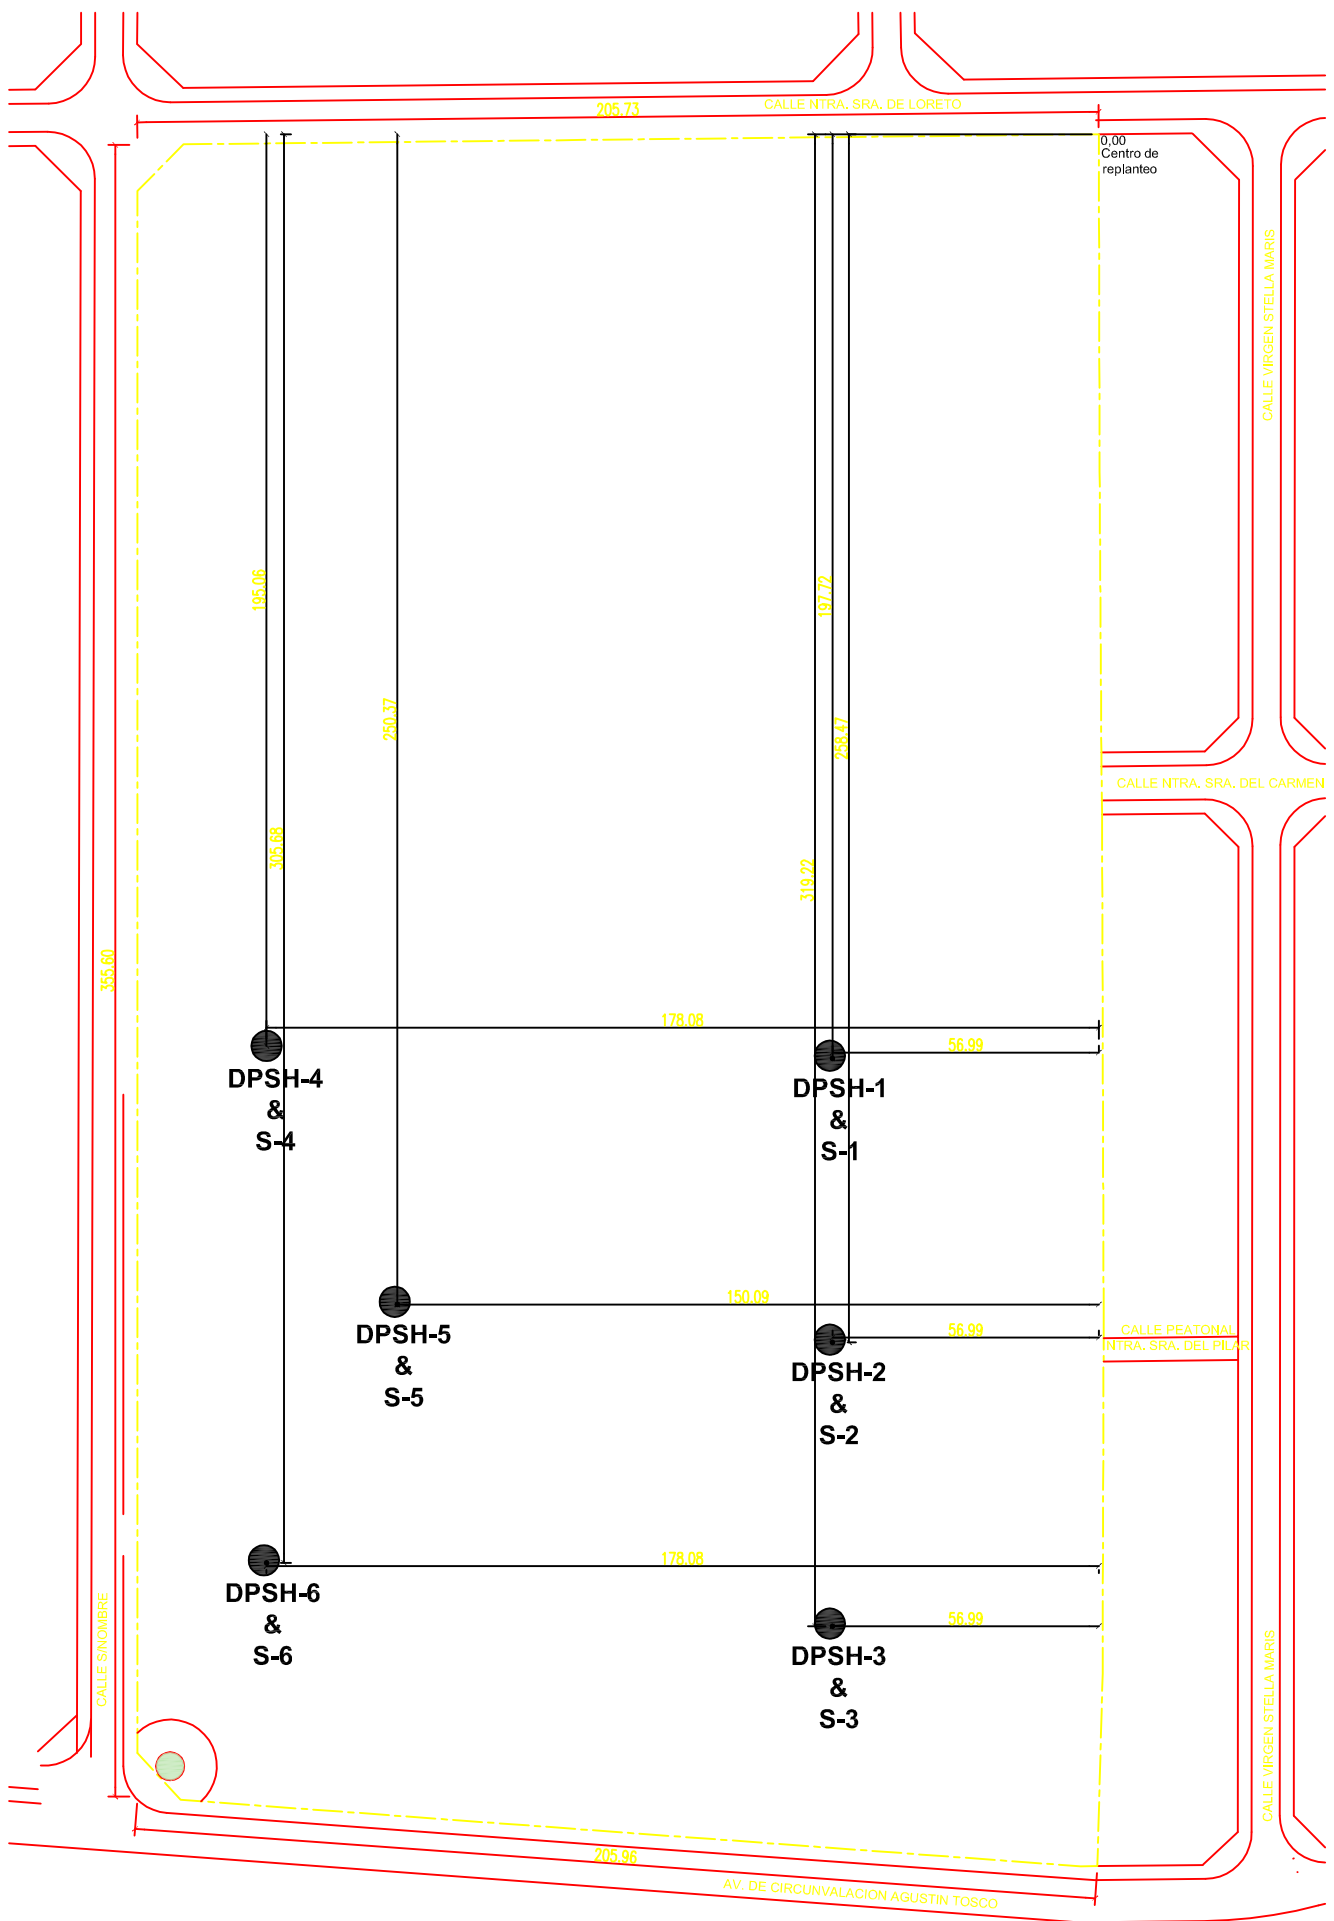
Lugar de ubicación en planta de sondeos geotécnicos
